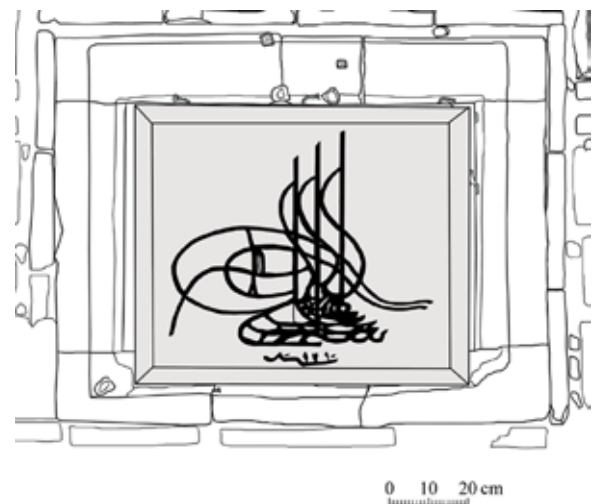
Реконструкція розташування накладної плити 1796 р. з тугрою на фасаді вежі № 11
